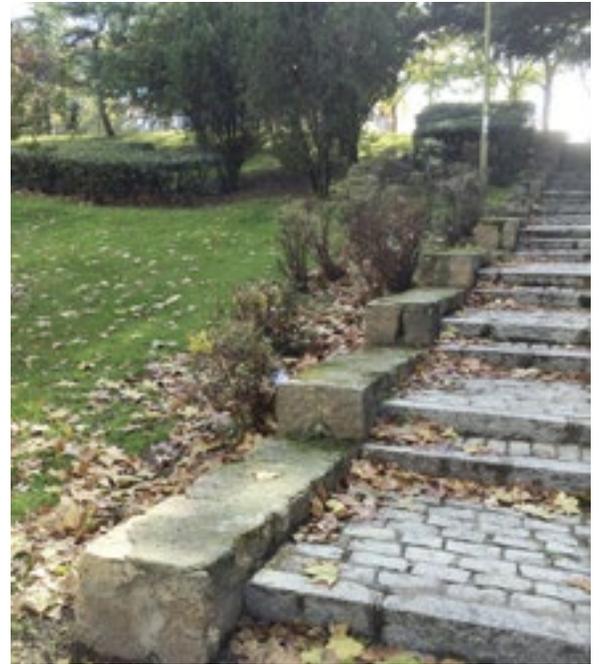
Muros, escaleras y pavimentos del Poblado Dirigido de Fuencarral. Fuente: Autor.
